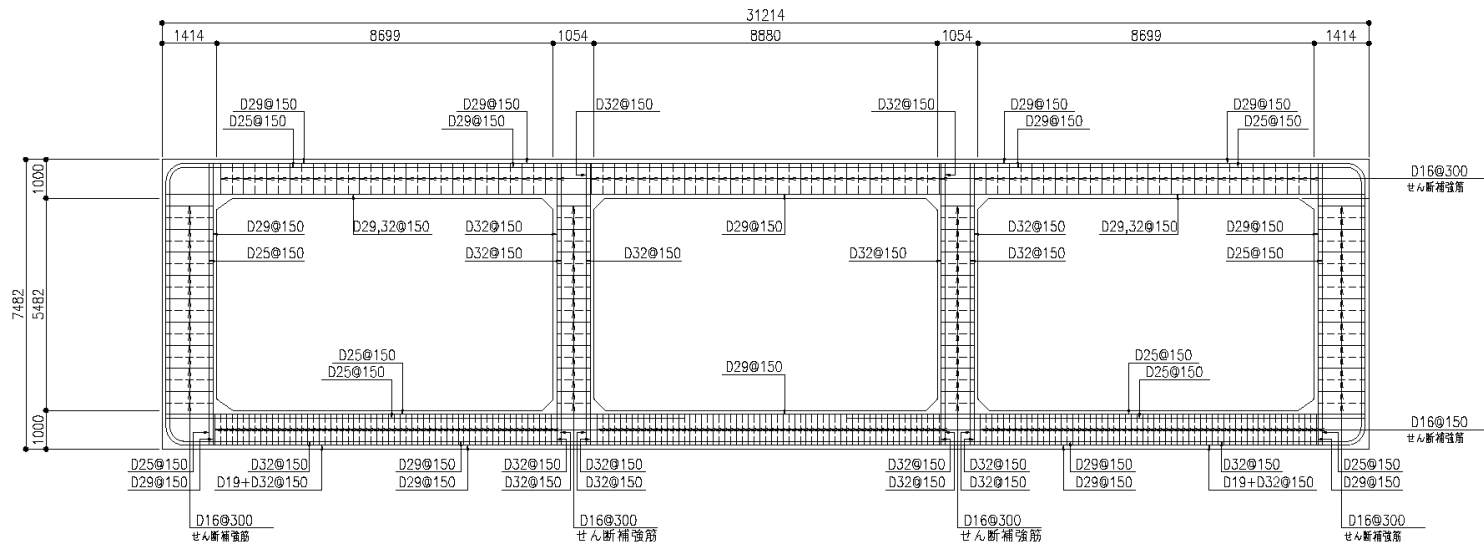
取水路 (6号機設備) の配筋図 (漸縮部, A-A断面)
